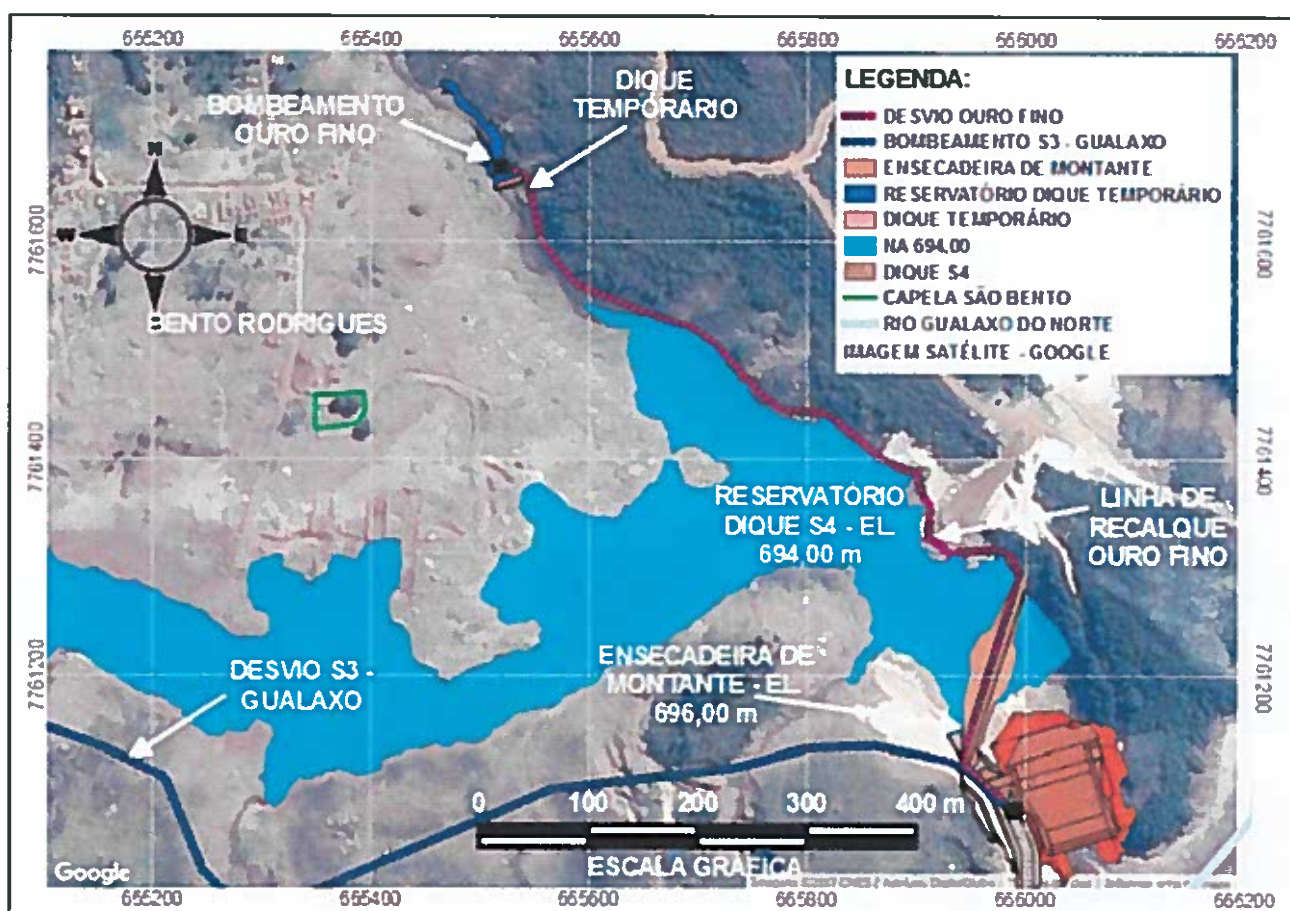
Vista em planta das estruturas de desvio do córrego Ouro Fino.
